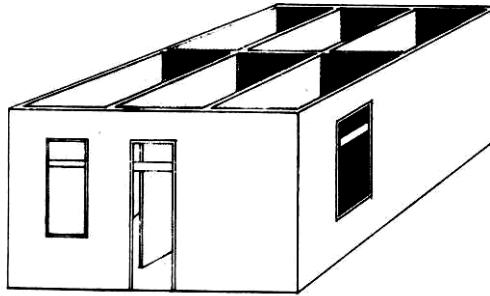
Denah bangunan gedung yang terdiri dari rangkaian bangunan simetris
